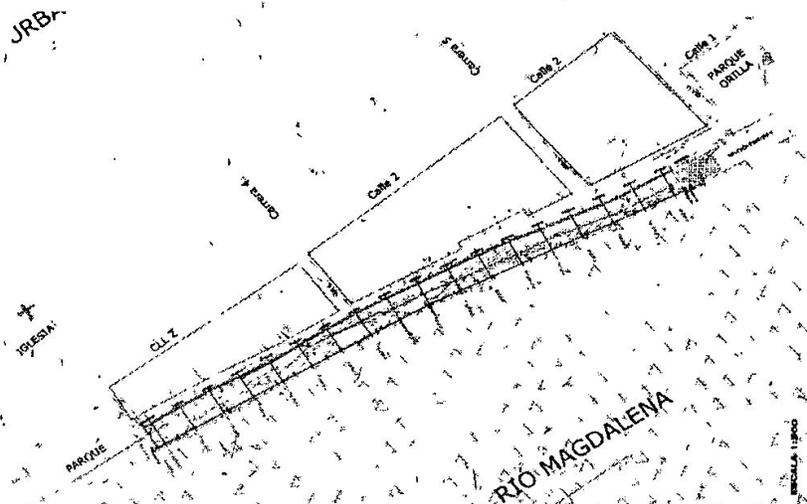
Detalle de implantación de la obra de protección propuesta en el Río Magdalena¹⁵.
